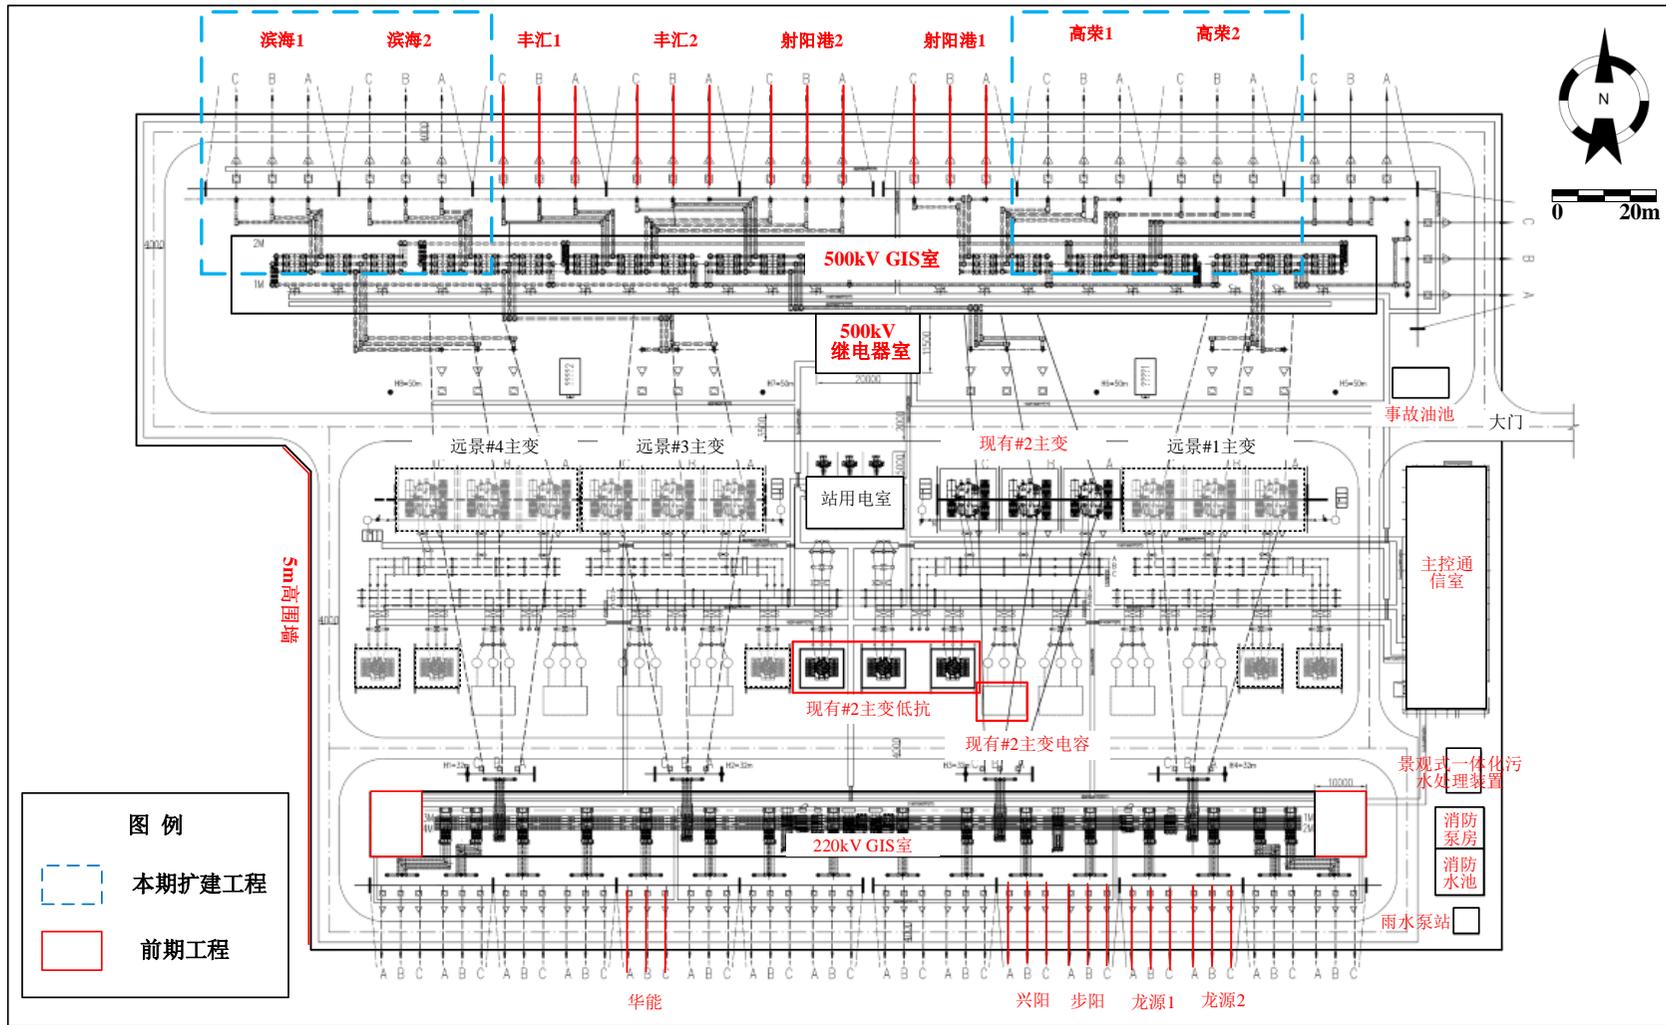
鹤栖 500kV 变电站总平面布置示意图
